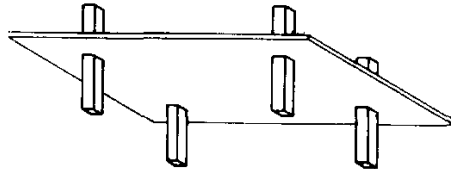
Modalidades de la losa plana de concreto reforzado.
